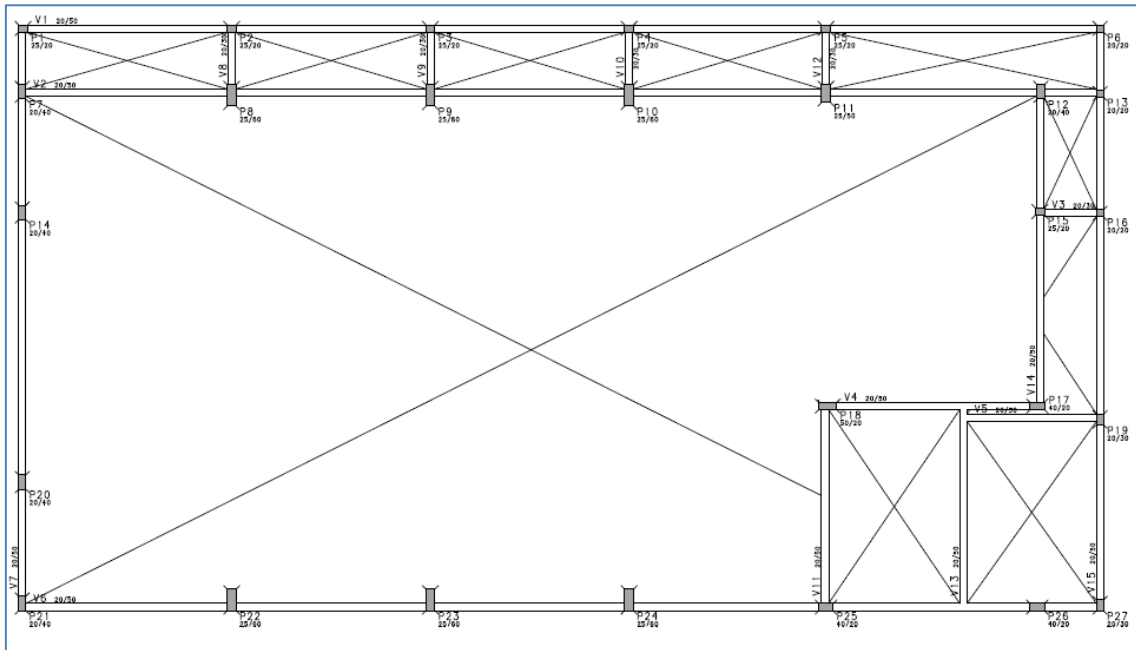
Planta de fôrma: fundação, concreto protendido (CAD/TQS)
